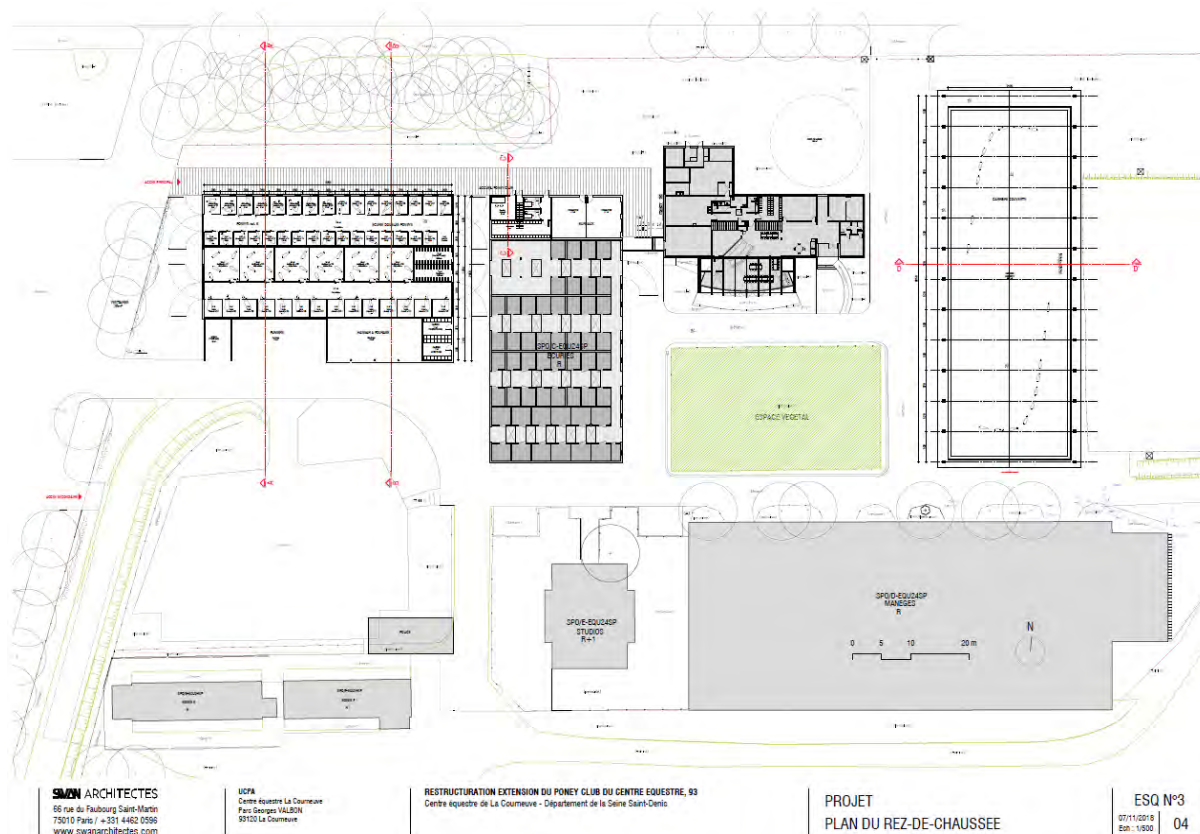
Plan de masse du projet au niveau du rez-de-chaussée
